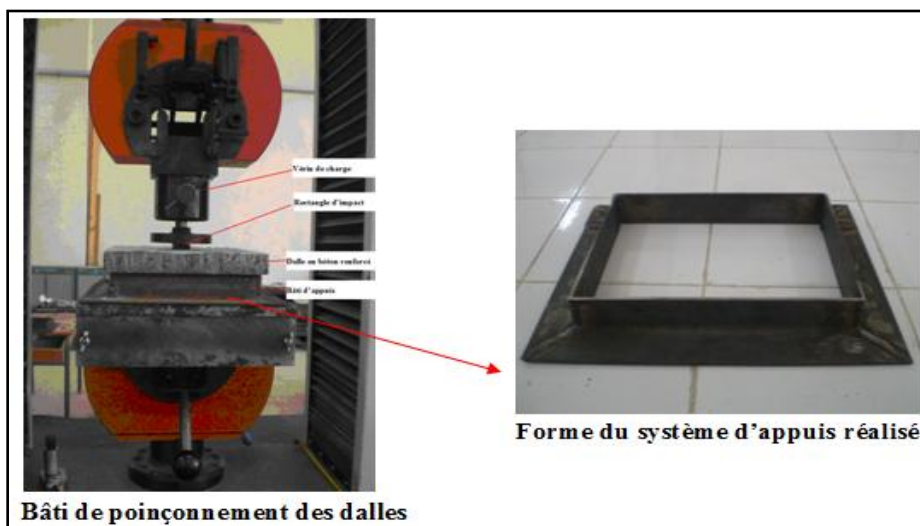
Mise en point du dispositif d'essai de poinçonnement.
